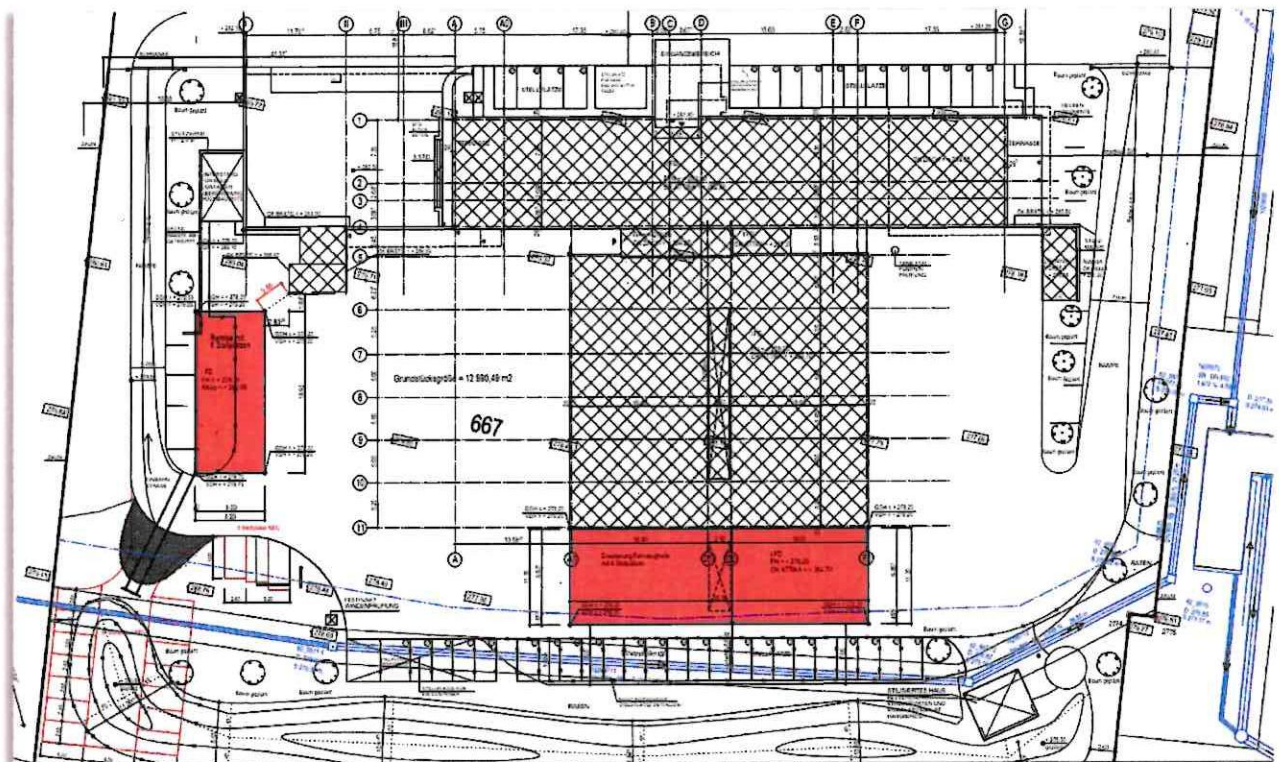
Lageplan aus Bauantragsunterlagen vom 20.02.2025
